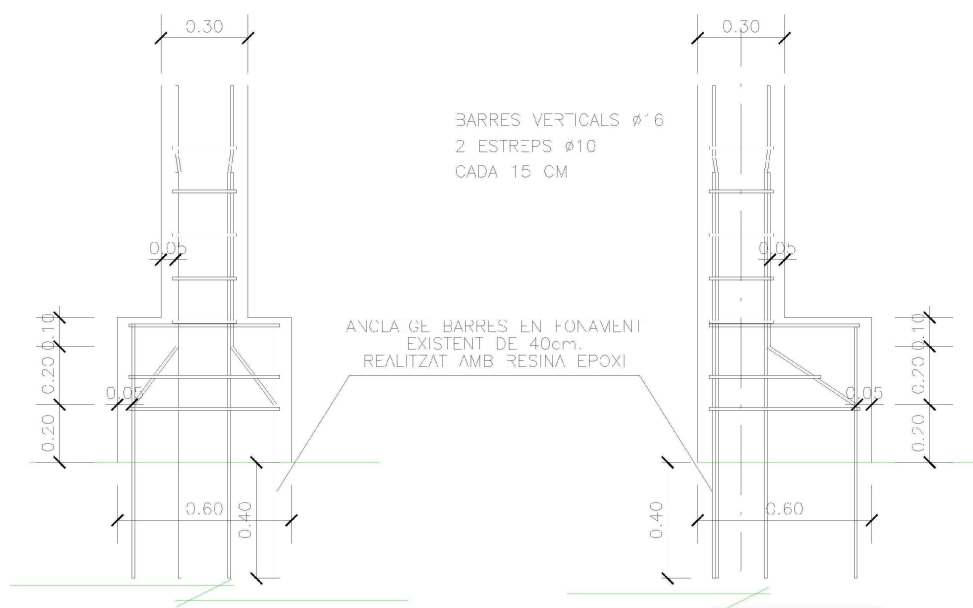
b. Esquema col·locació armats recrescuts i esperes pilars
